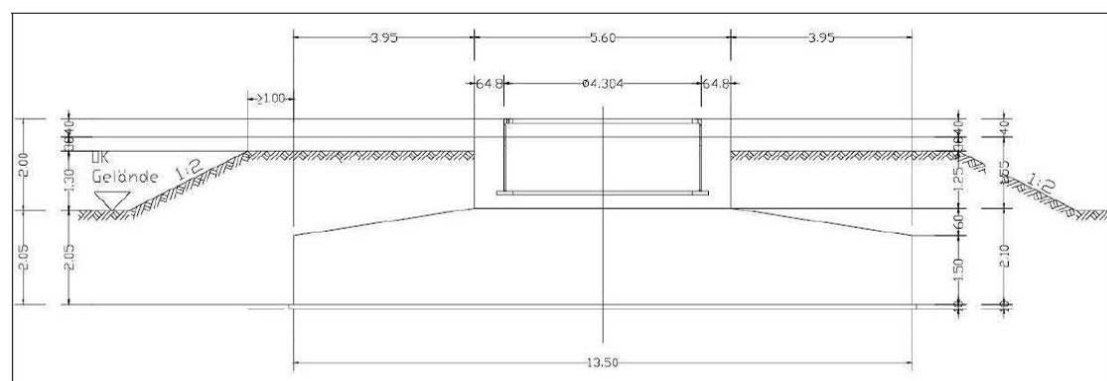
Schéma de principe en coupe pour la réalisation d'une fondation
